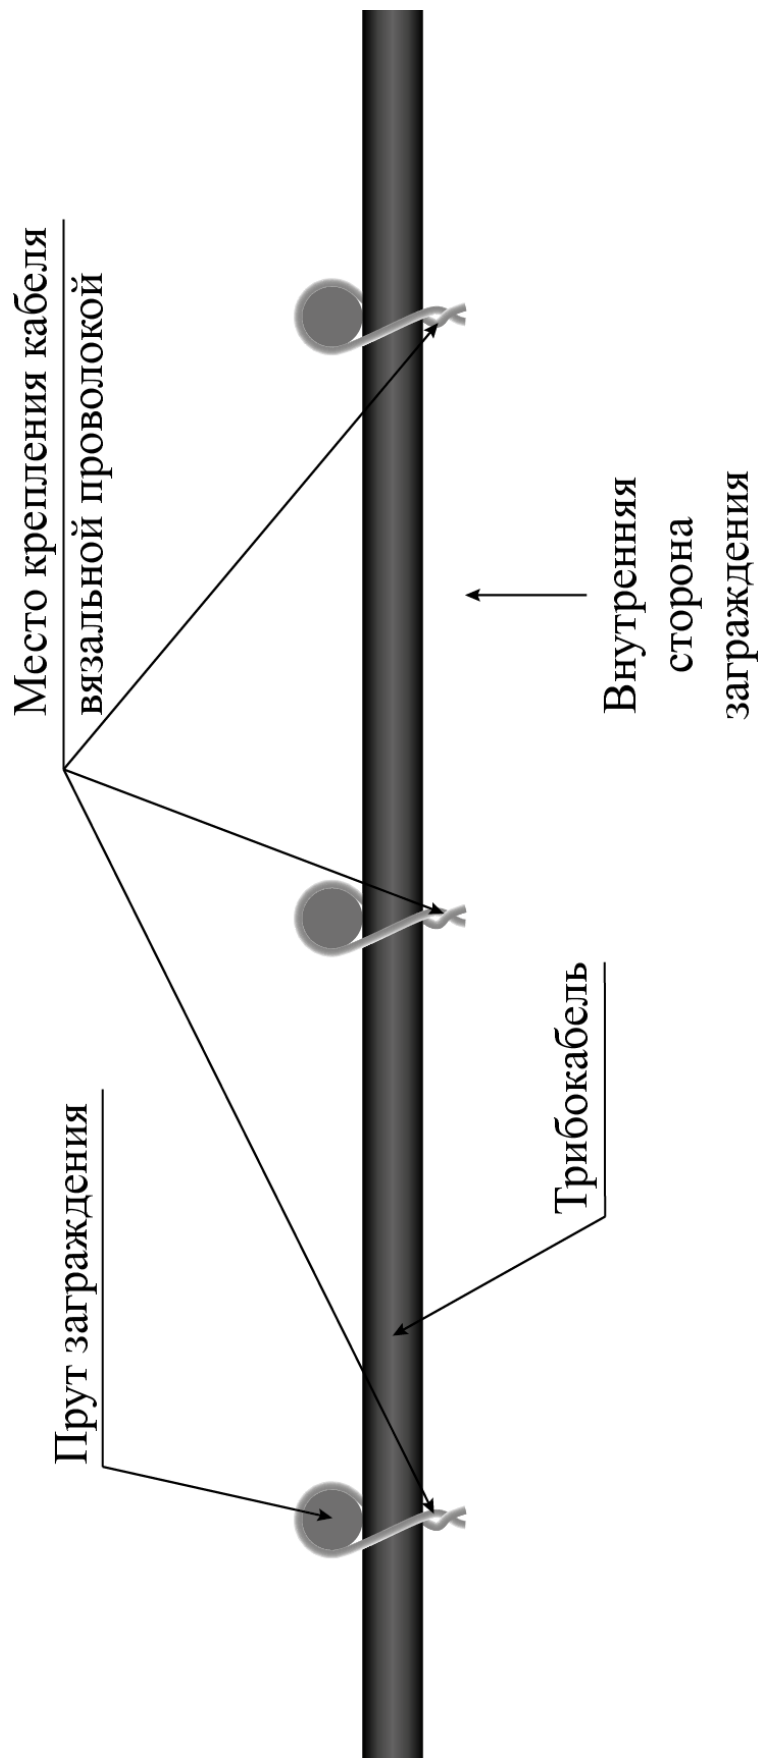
Вариант крепления ЧЭ (трибокабеля) к ограждению из сварных (кованых) решеток
